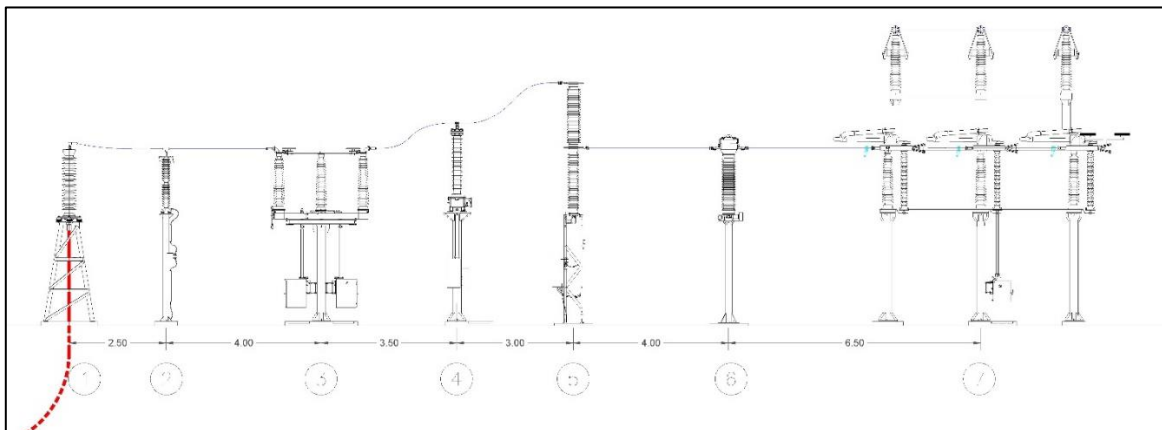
Sezione A-A' - Sistema di sbarre di raccolta AT
